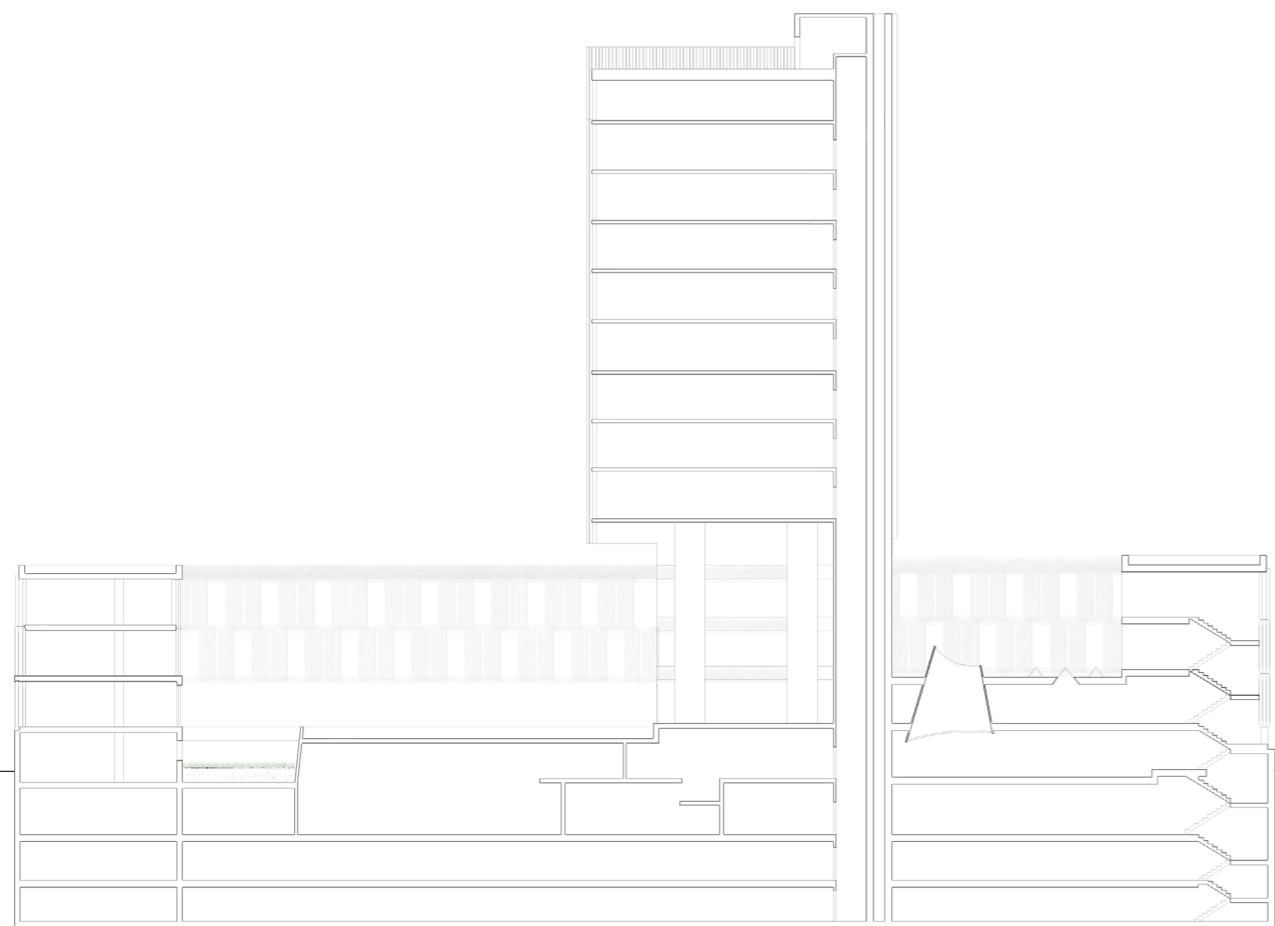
Coupe longitudinale du bâtiment avant-projet de reconversion
